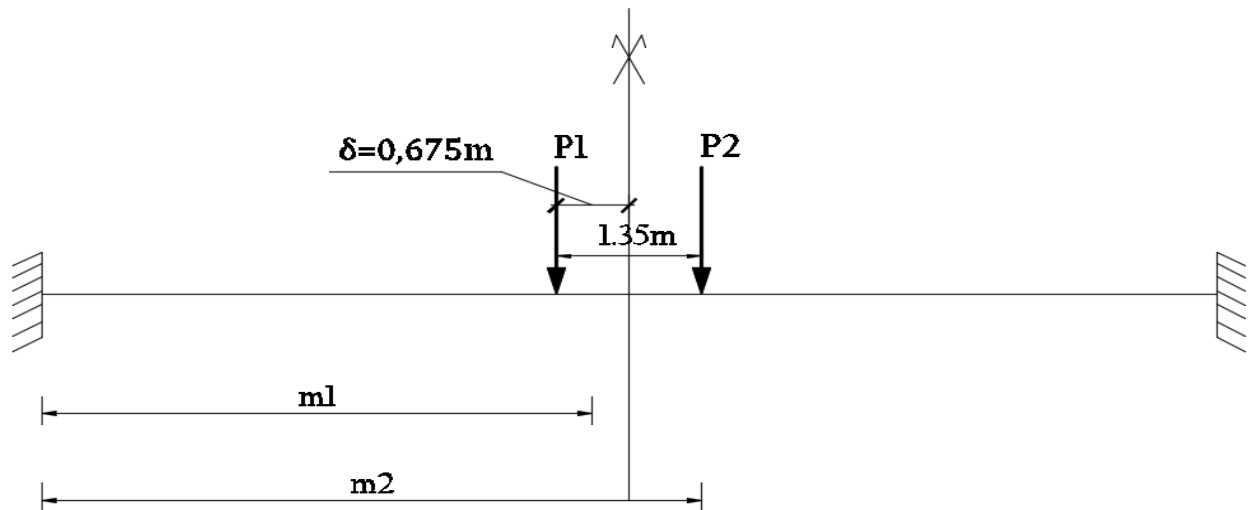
disposition la plus défavorable des essieux du convoi Bt longitudinalement
